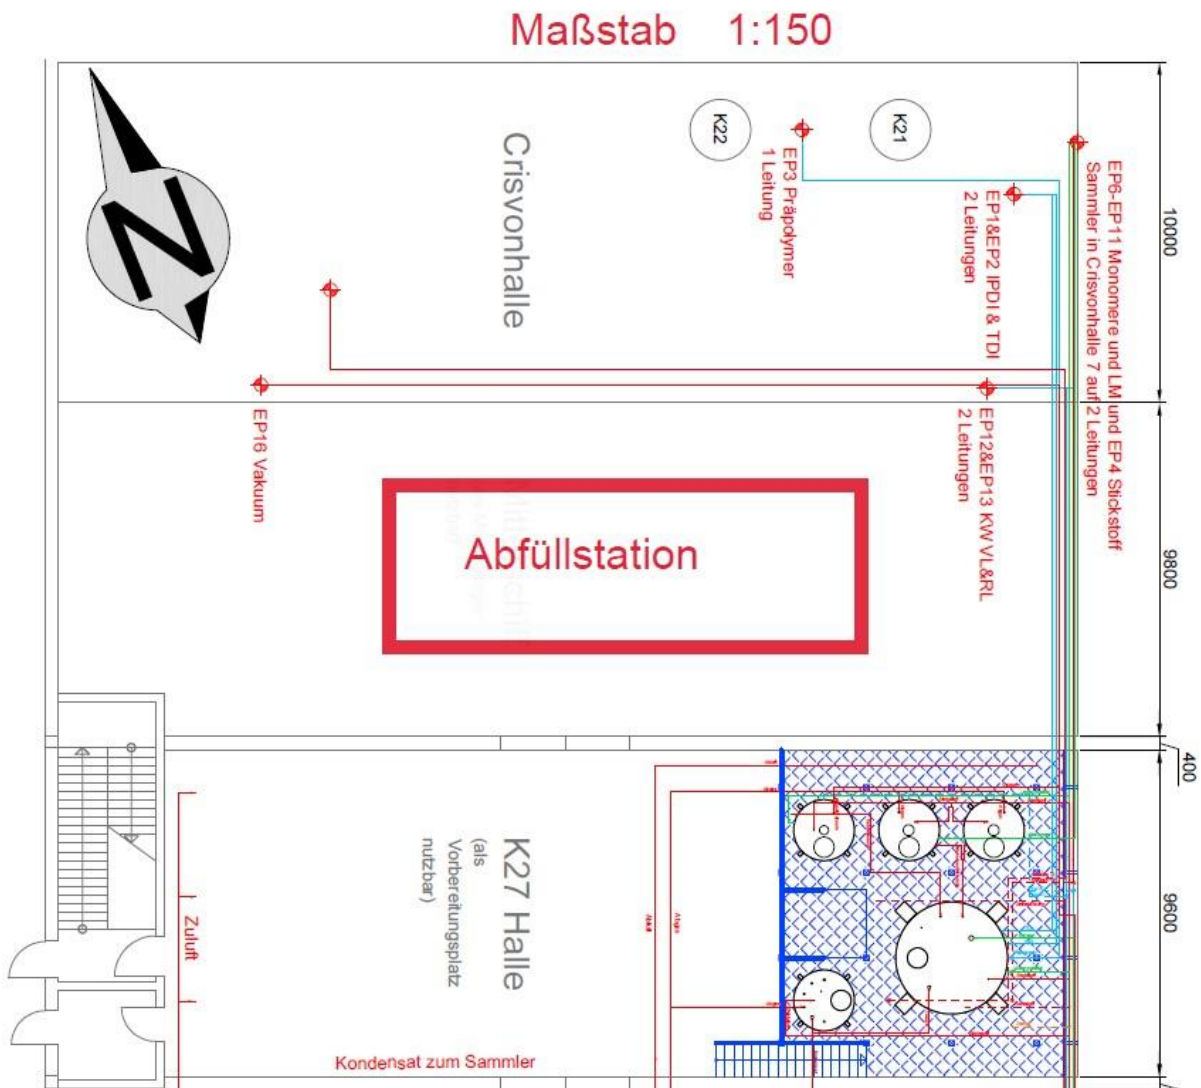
| Grundriss des Aufstellungsortes der Abfüllanlage (Eigendarstellung Firma DIC)
